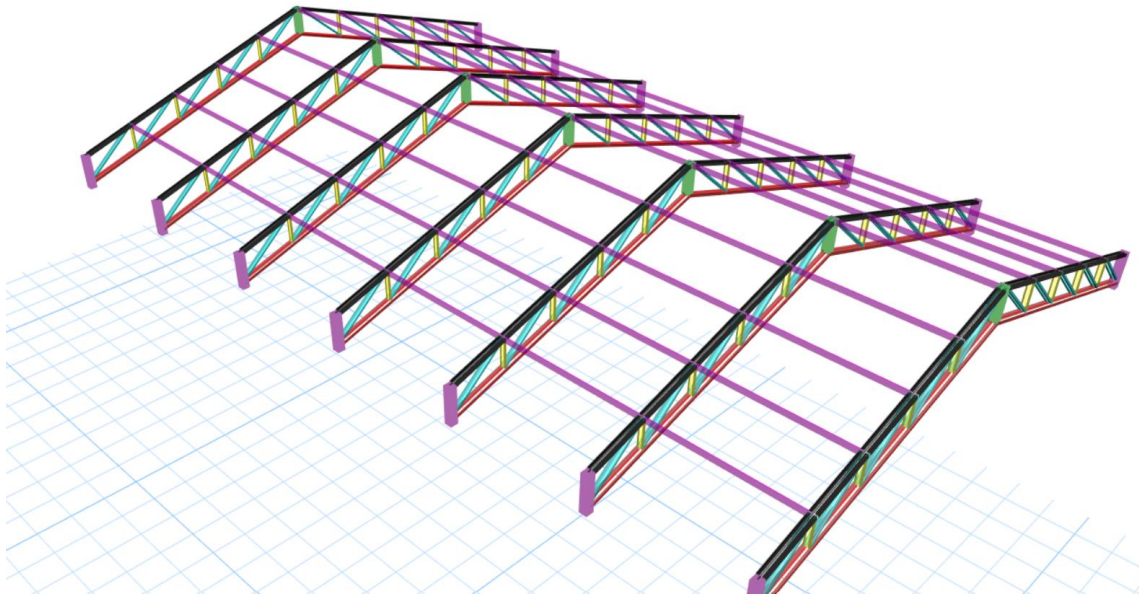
Modelación 3D – Cubierta edificio 1.
